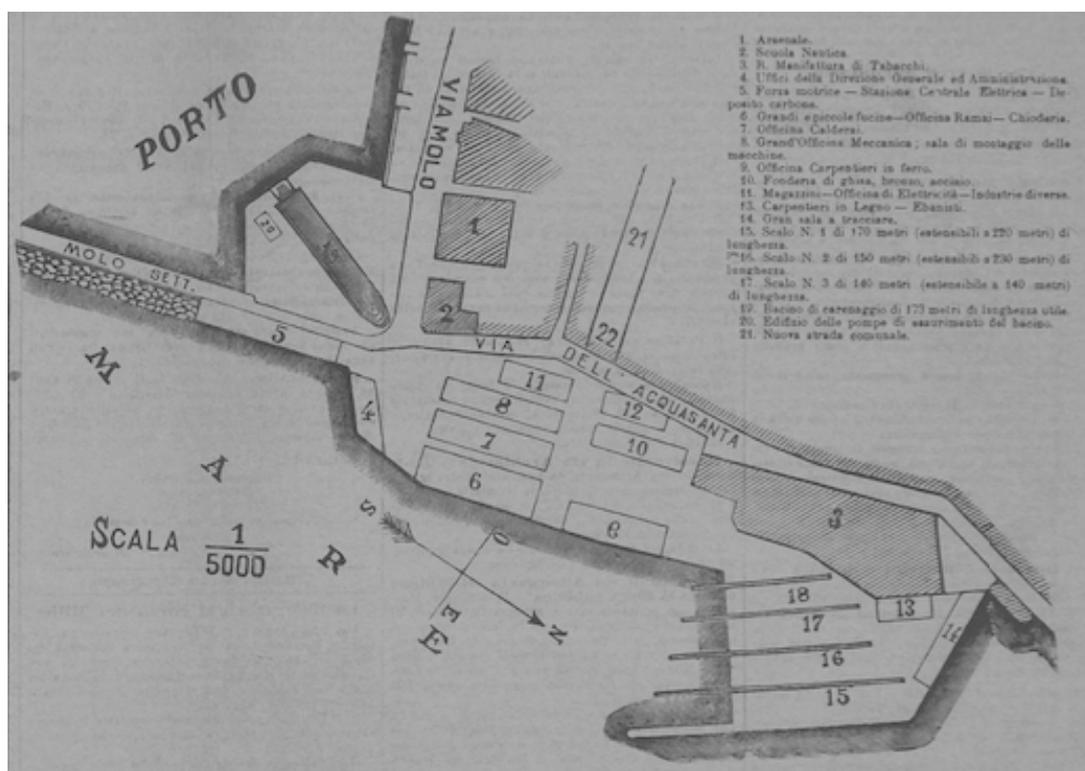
Planimetria del cantiere navale. A meno della posizione del bacino, la dislocazione delle strutture cantieristiche non risponde a quanto realizzato Fonte: «Corriere dell'Isola», del 20 marzo 1897, Anno V n. 78
